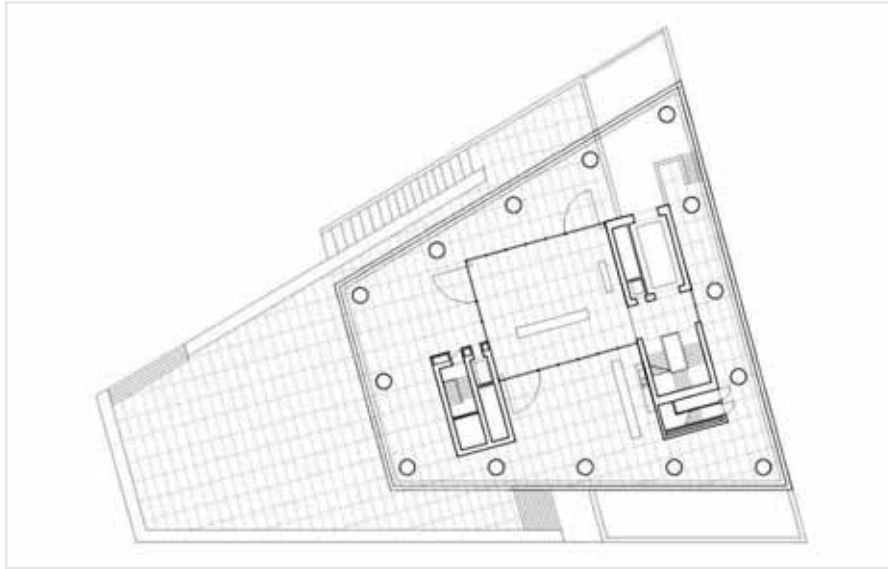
Museo Jumex, planta baja. <http://www.archdaily.mx/mx/626552/museo-jumex-abre-sus-puertas>
